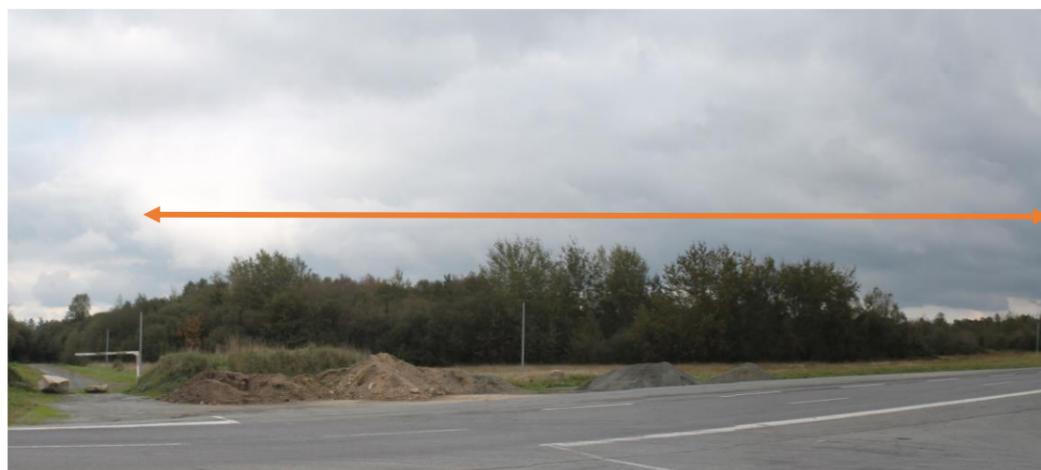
Entrée du terrain, site boisé, Façade Sud-Ouest. Sources : Photo E. Delachapelle
